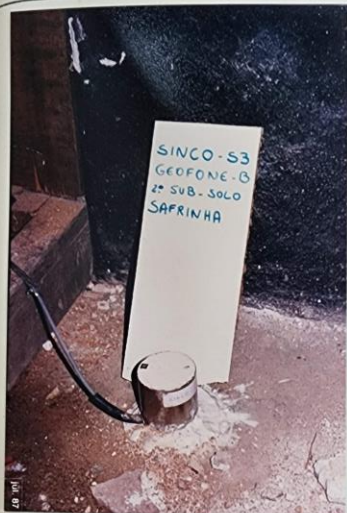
Instalação de um geofone na laje do 2º subsolo do Edifício Segurasil, próximo de um pilar.
